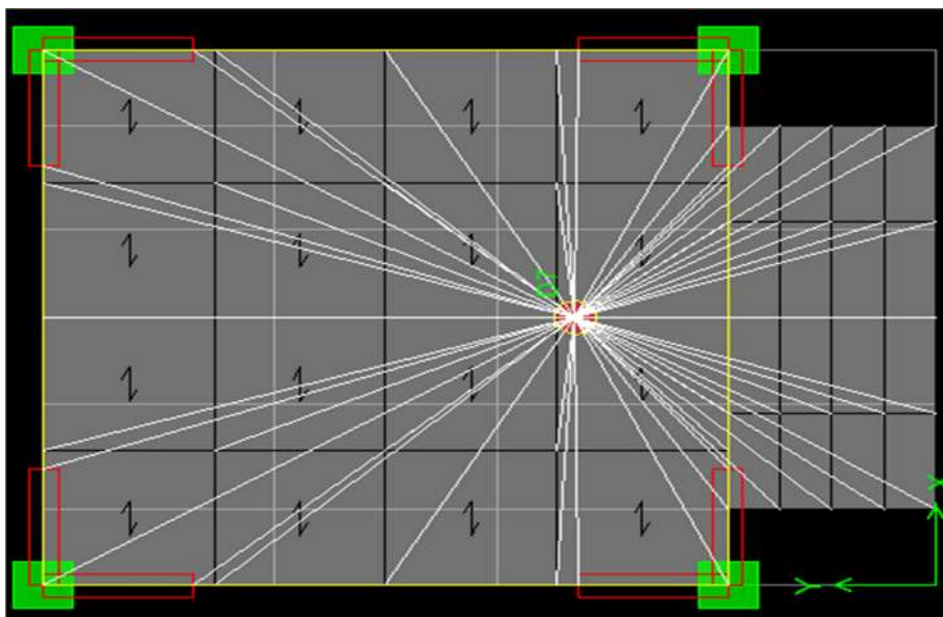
Liaison des planchers terrasse (Diaphragmes).
